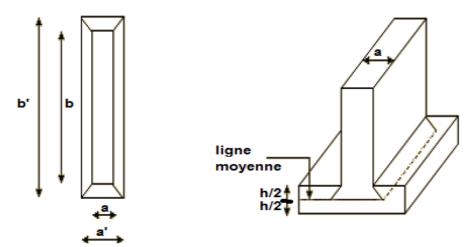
Schéma de transmission des charges sur le radier sous voile.
